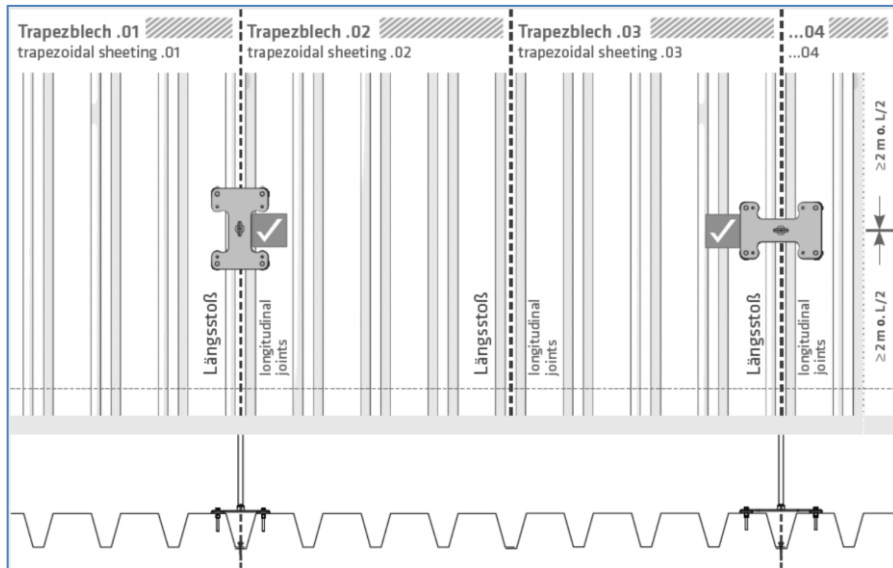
Montagevorgaben auf Trapezprofil bei Absturzrichtung quer zur Trapezprofilspannrichtung
